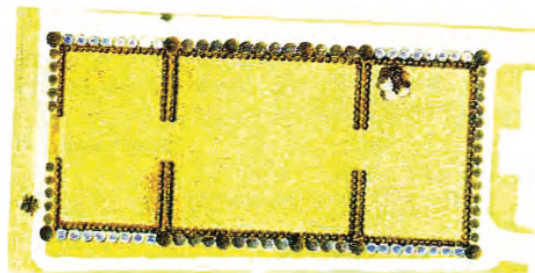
Planta general de la propuesta para el Tramo 9. (Vigil de Insausti, 2012)
